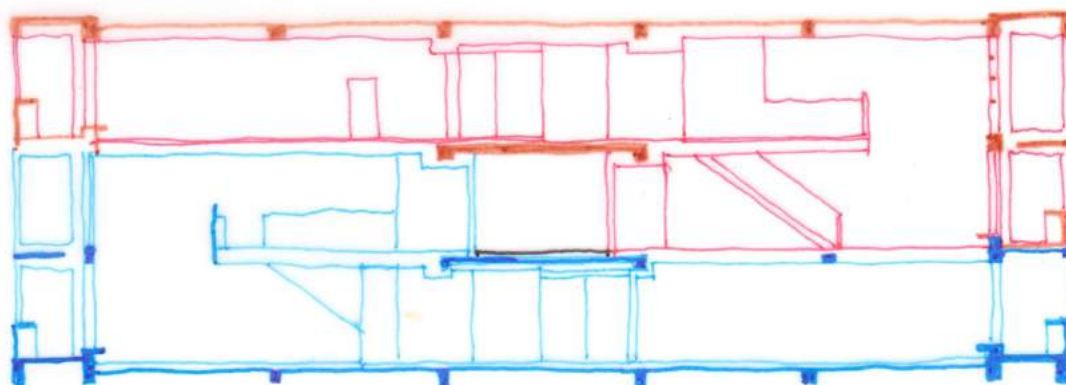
Le principe d'assemblage de deux duplex. Plans libres.
